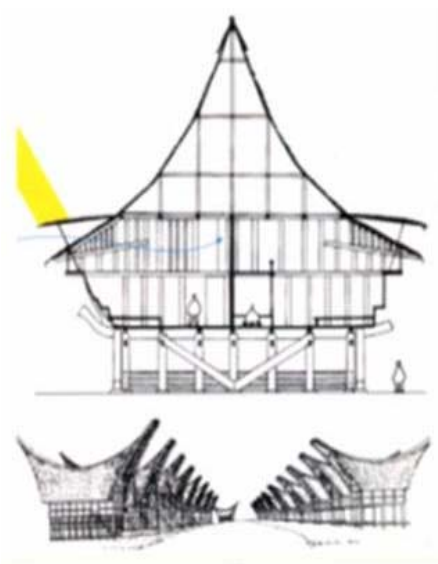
Construções vernaculares da Indonésia. Fonte: BEHLING, 1996.
